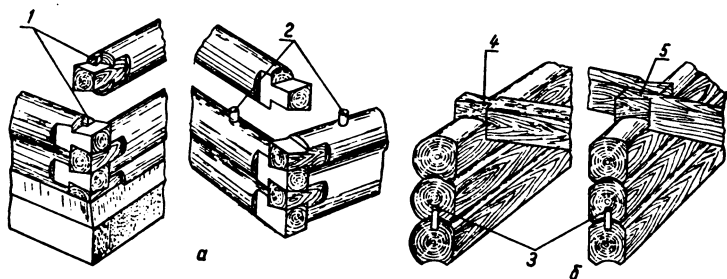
Рубка стен из бревен «в лапу»: а — с коренным шипом; б — укладка и крепление балок в стенах; 1 — коренной шип; 2 — вставной шип; 3 — зазор; 4 — крепление одной балки; 5 — крепление двух балок.
